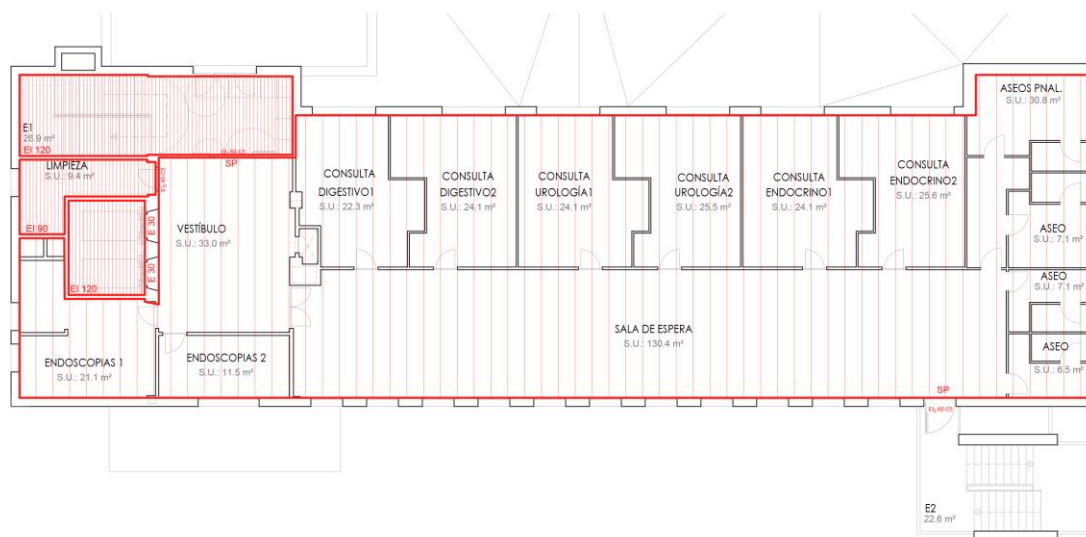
Planta de sectorización de la planta segunda. (Planta tipo)
